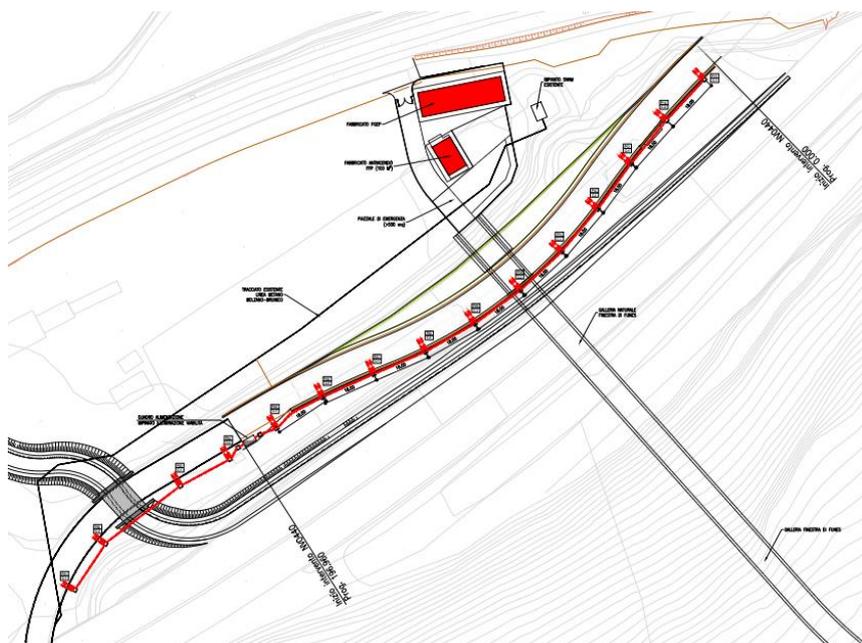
Planimetria di progetto impianto di illuminazione NV044
